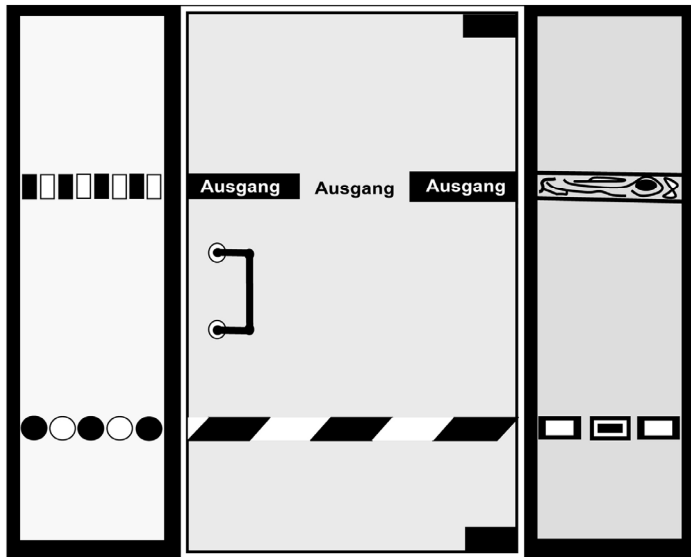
Visuelle Orientierung für Personen mit Sehbehinderungen durch mögliche Sicherheitsmarkierungen an einer Tür
